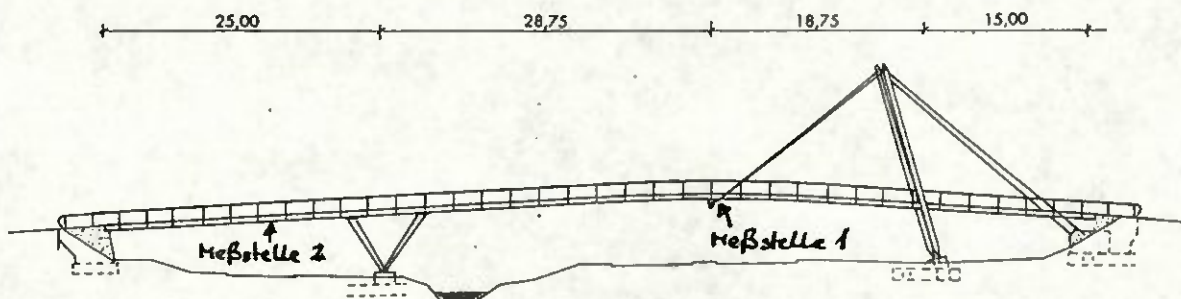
System der Brücke (In: bauen mit holz (1996) S. 863-869)
